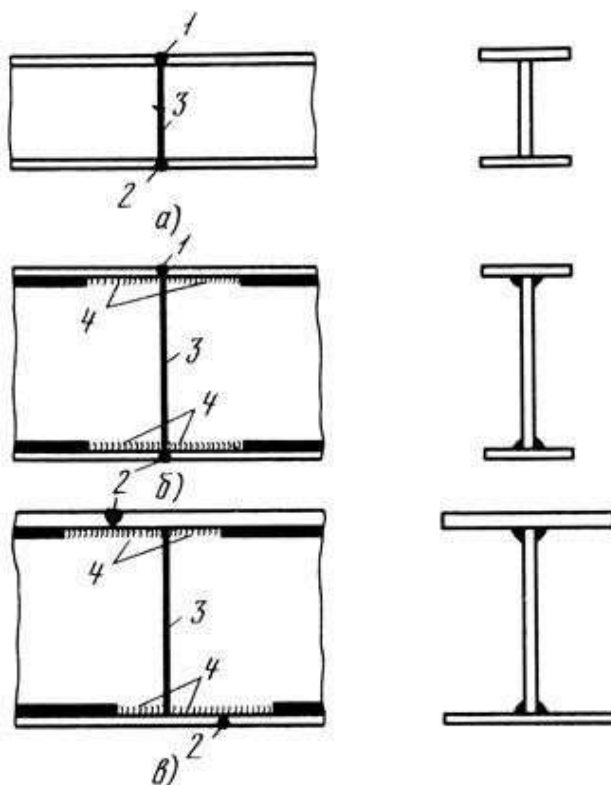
Порядок сварки монтажных стыков балок: а - прокатных, б и в - сварных; 1 - 4 - последовательность выполнения сварки
